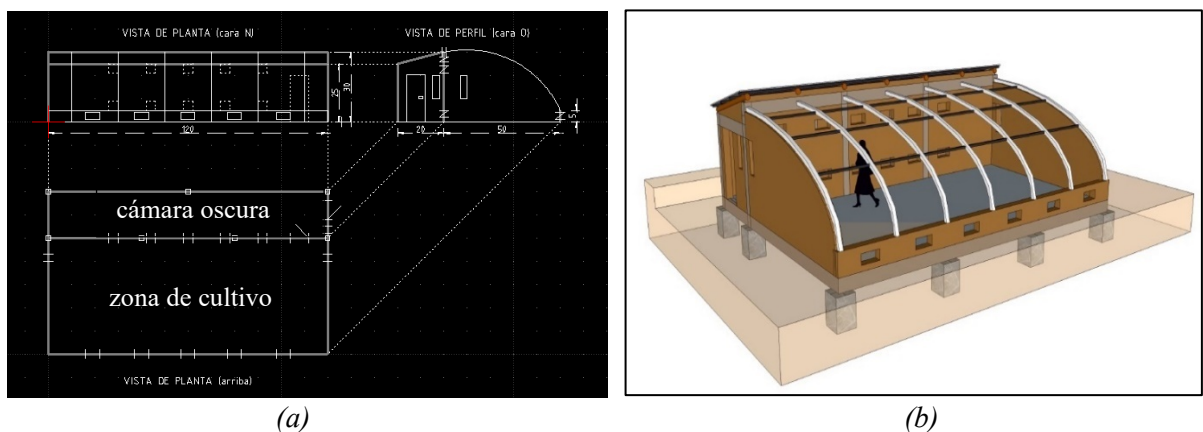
Invernadero, (a) vista de planta y de perfil, (b) esquema en 3D.
